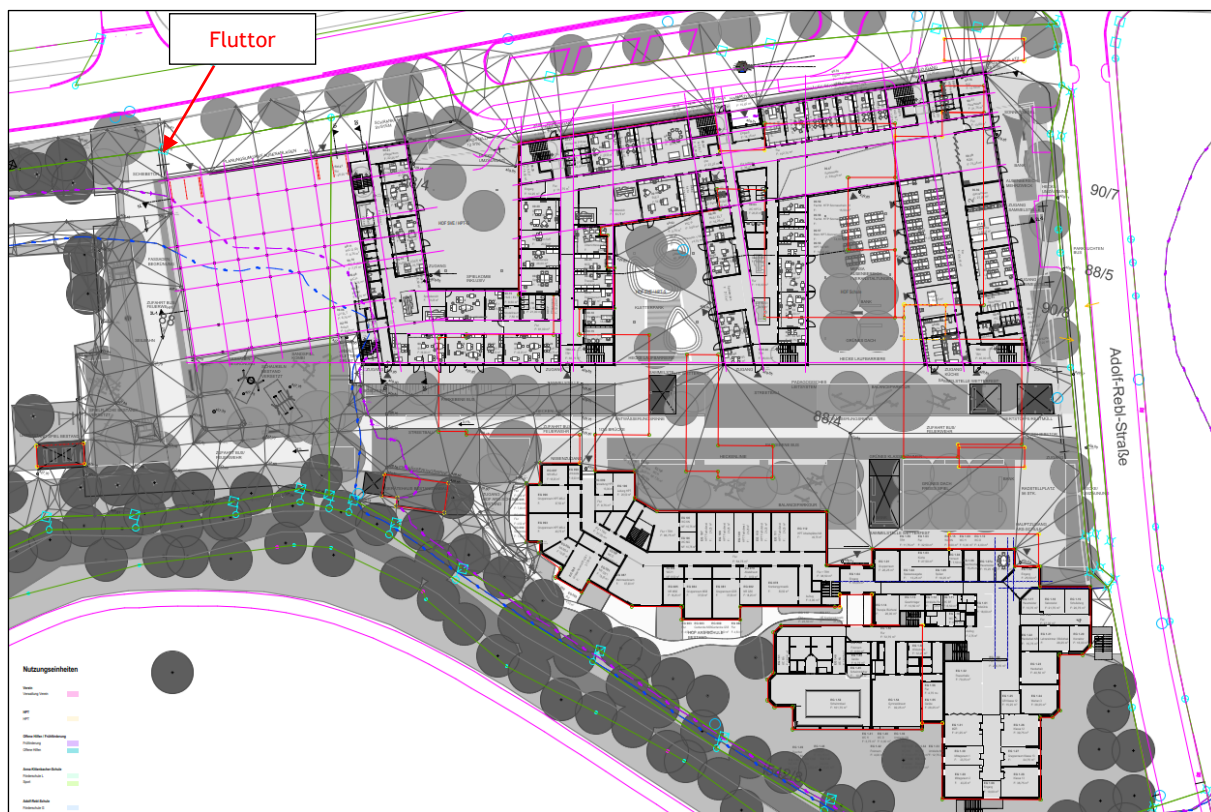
Plan der geplanten HPZ-Erweiterung mit Freiflächen⁶
